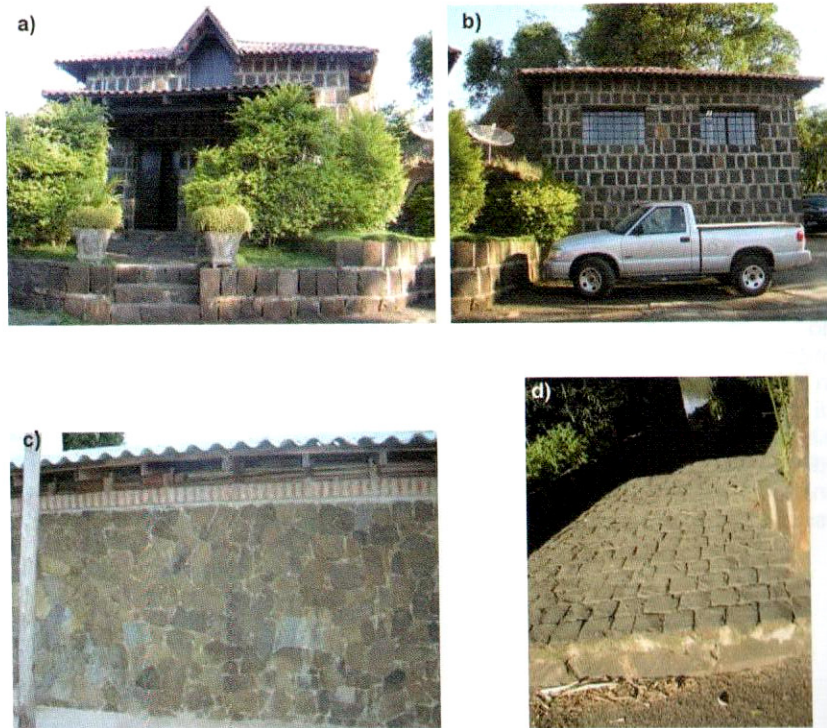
Fotografie a,b,c,d. Esempi dell'uso ornamentale delle rocce basaltiche in facciate e pavimenti grezzi - Photos a, b, c and d. Examples of the ornamental use of basaltic rocks in façades and rustic paving.
